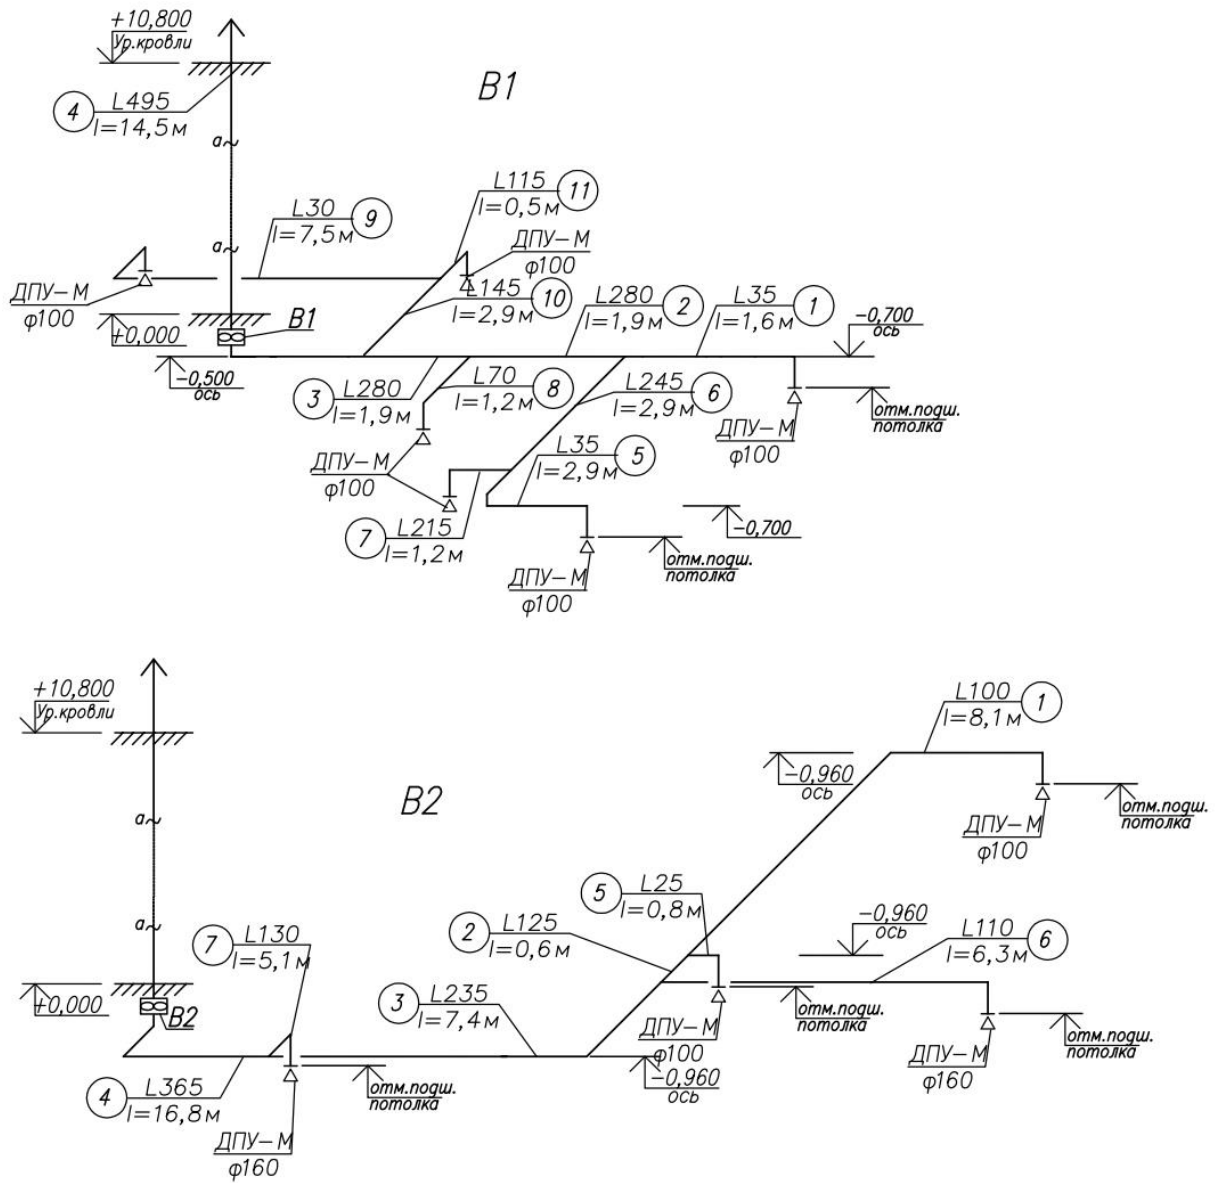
Расчетные схемы систем вентиляции В1, В2
